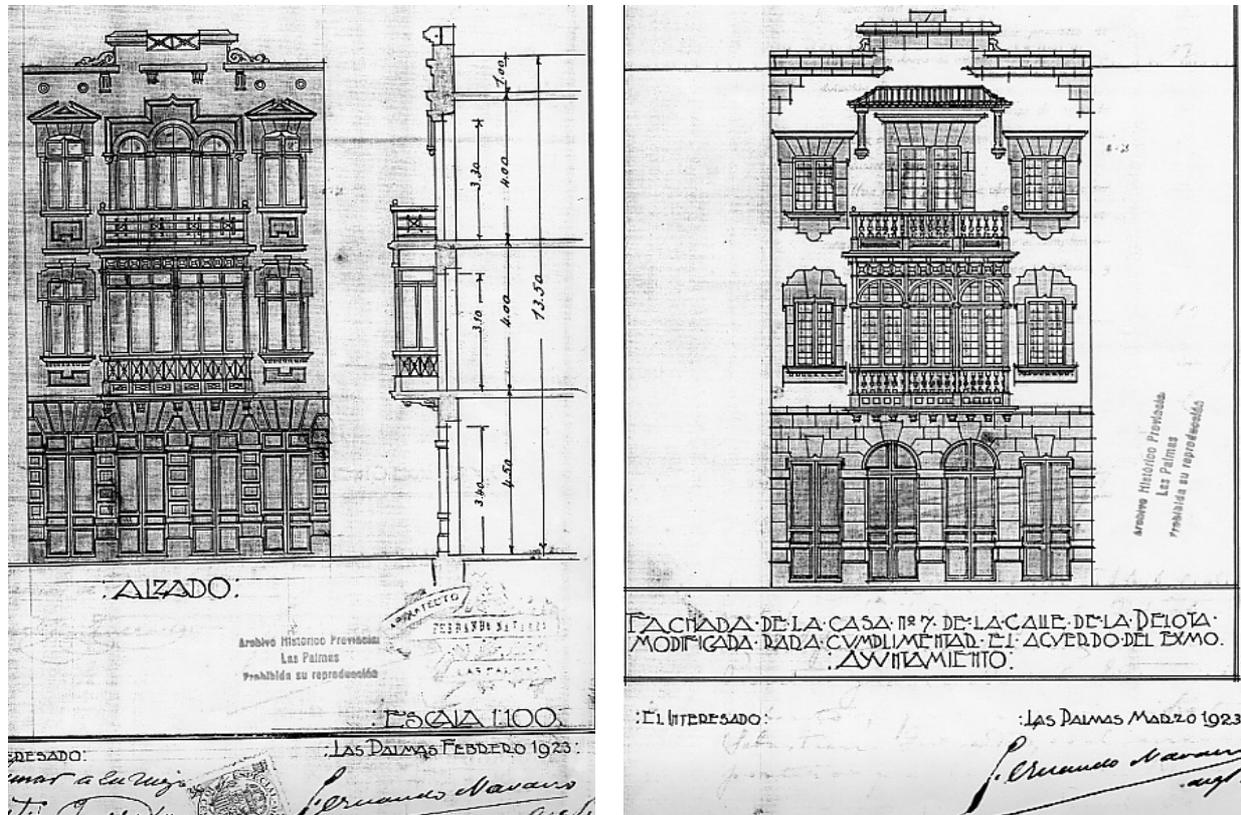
F. Navarro. Casa de tres plantas para D. Miguel Bautista Almeida (1923); a) primer alzado; b) alzado modificado. C/ Pelota. AHP de LP: P. y O. Leg. 60; exp. 10.
